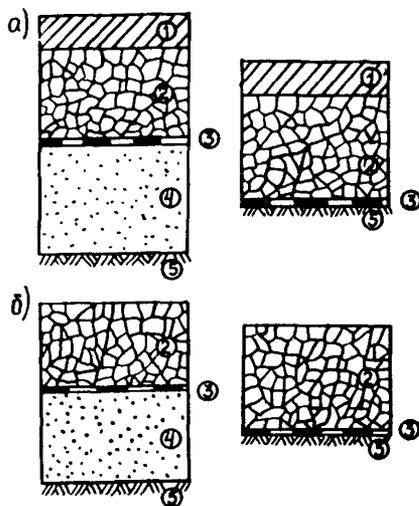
Конструкции армированных дорожных одежд усовершенствованного (а) и переходного (б) типов: 1-слои (слой) асфальтобетона; 2-щебеночный слой основания (покрытия); 3-армирующая сетка; 4-песчаный подстилающий слой; 5-грунт земляного полотна
